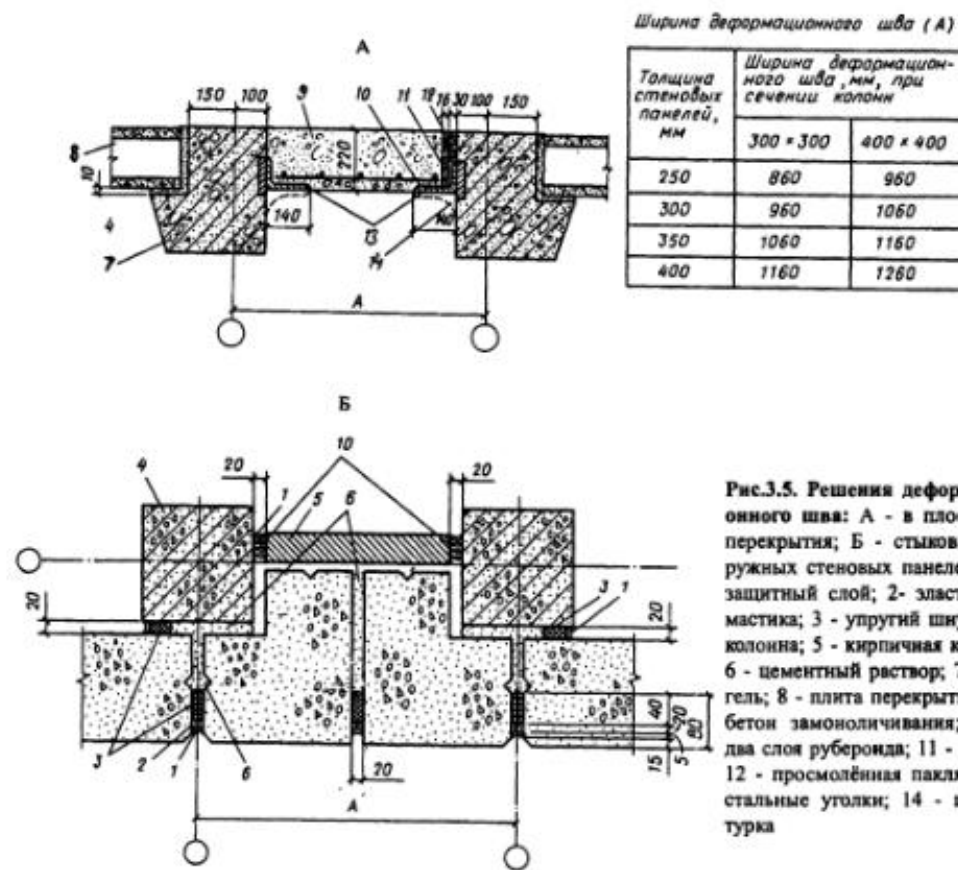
Решения деформационного шва: А - в плоскости перекрытия; Б - стыковка наружных стеновых панелей; 1 - защитный слой; 2 - эластичная мастика; 3 - упругий шнур; 4 - колонна; 5 - кирпичная кладка; 6 - цементный раствор; 7 - ригель; 8 - плита перекрытия; 9 - бетон замоноличивания; 10 - два слоя рубероида; 11 - доска; 12 - просмоленная пакля; 13 - стальные уголки; 14 - штукатурка
